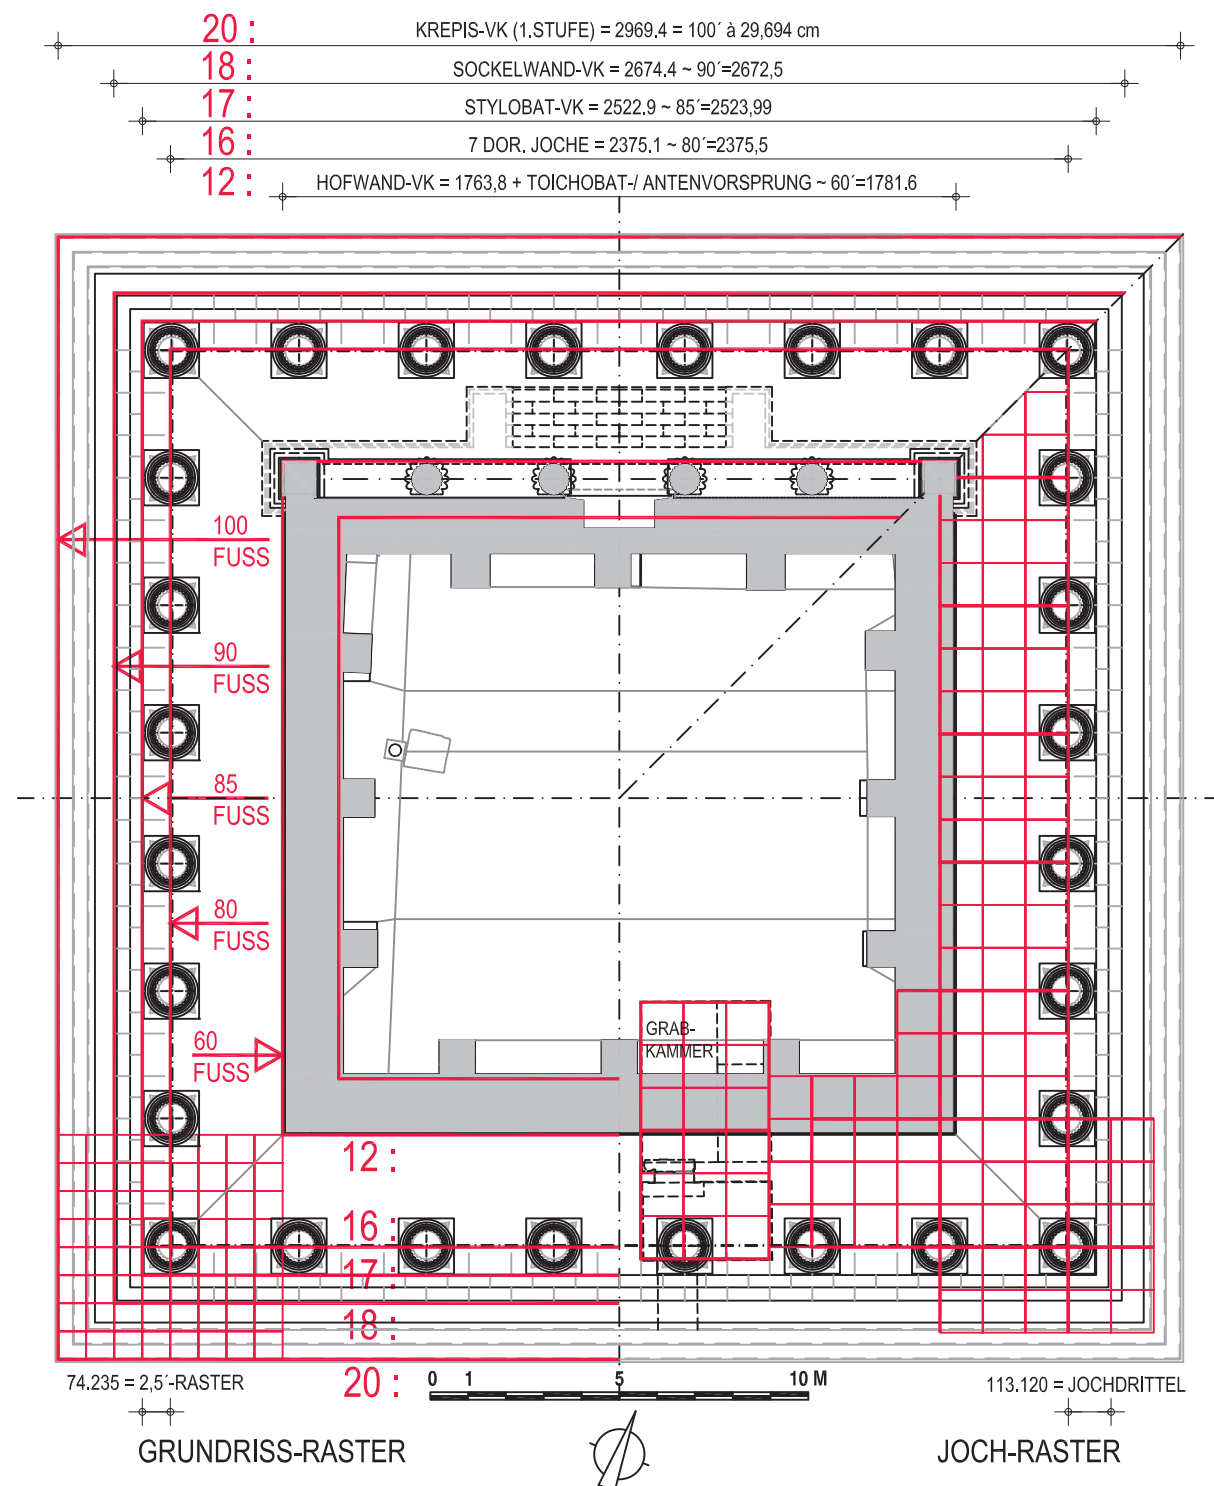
Grundrissraster und Jochraster, M = 1 : 200
